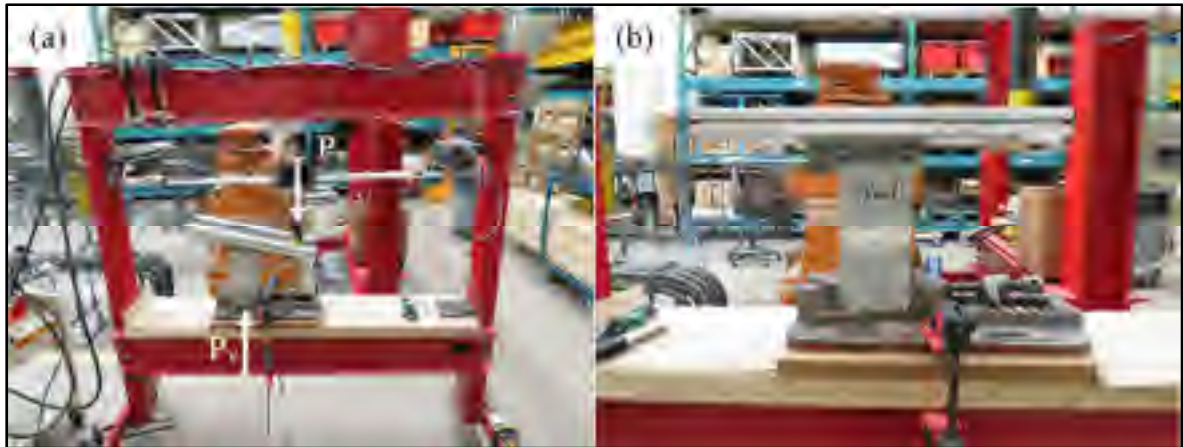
Montage expérimental des essais de flexion du joint: (a) cadre du montage, (b) vue rapprochée des serres
